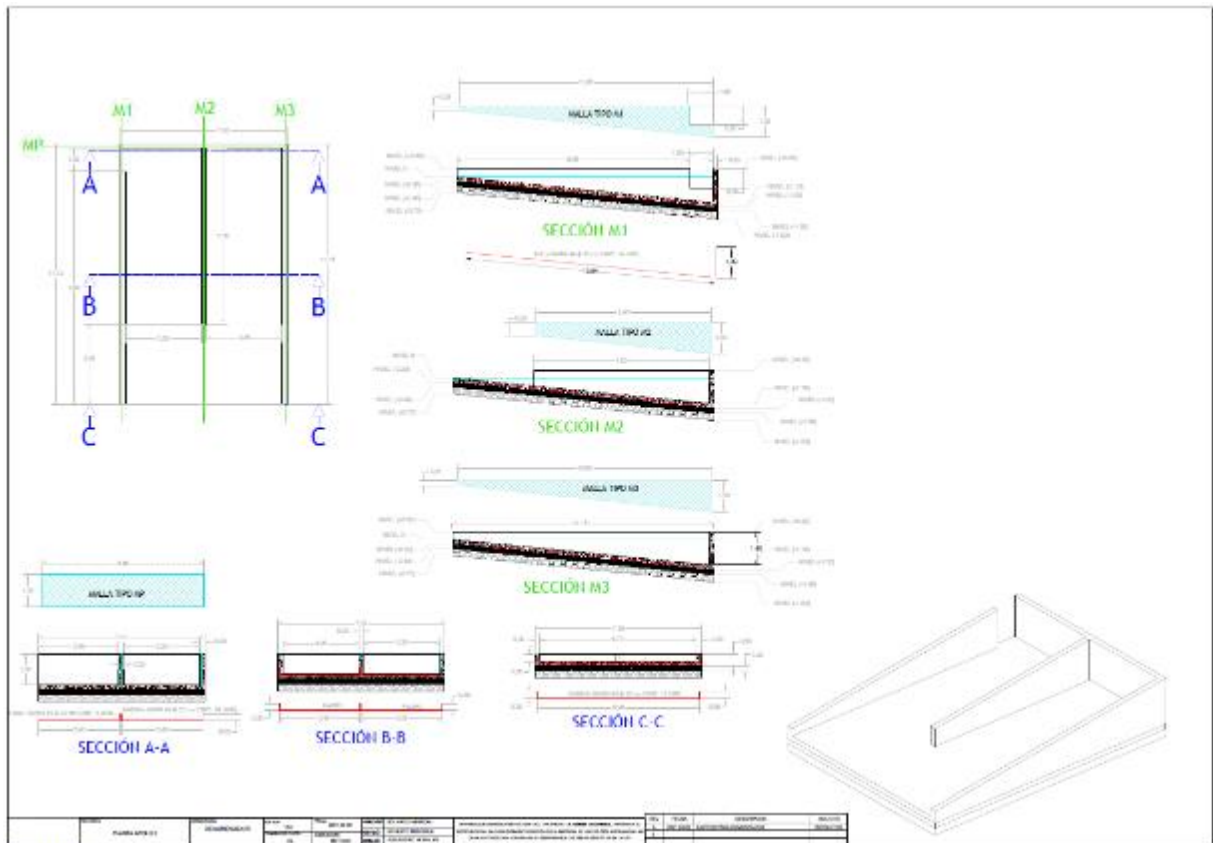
Plano de construcción de sedimentadores para la planta de concreto
